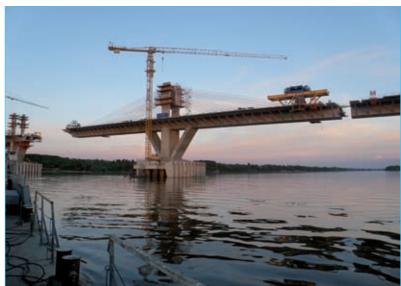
Construcción en avance en voladizo con dovelas prefabricadas
